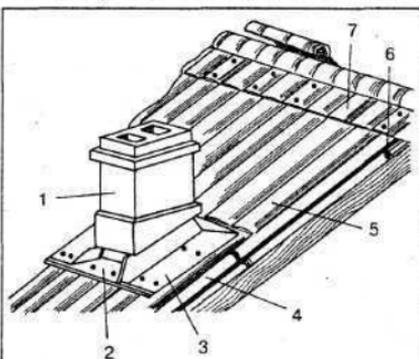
Устройство воротника трубы для кровли из асбестоцементных листов:
